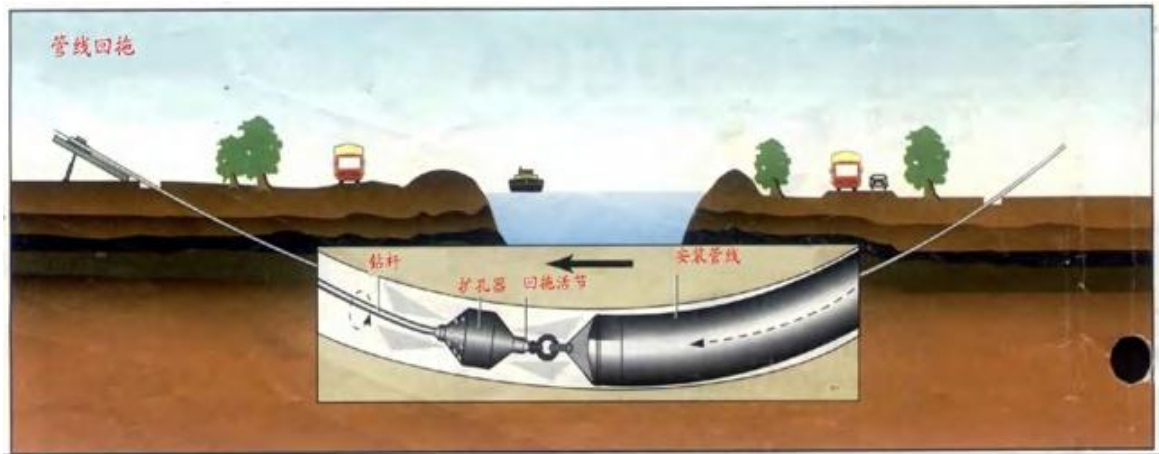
定向钻穿越施工管线回拖过程断面示意图
